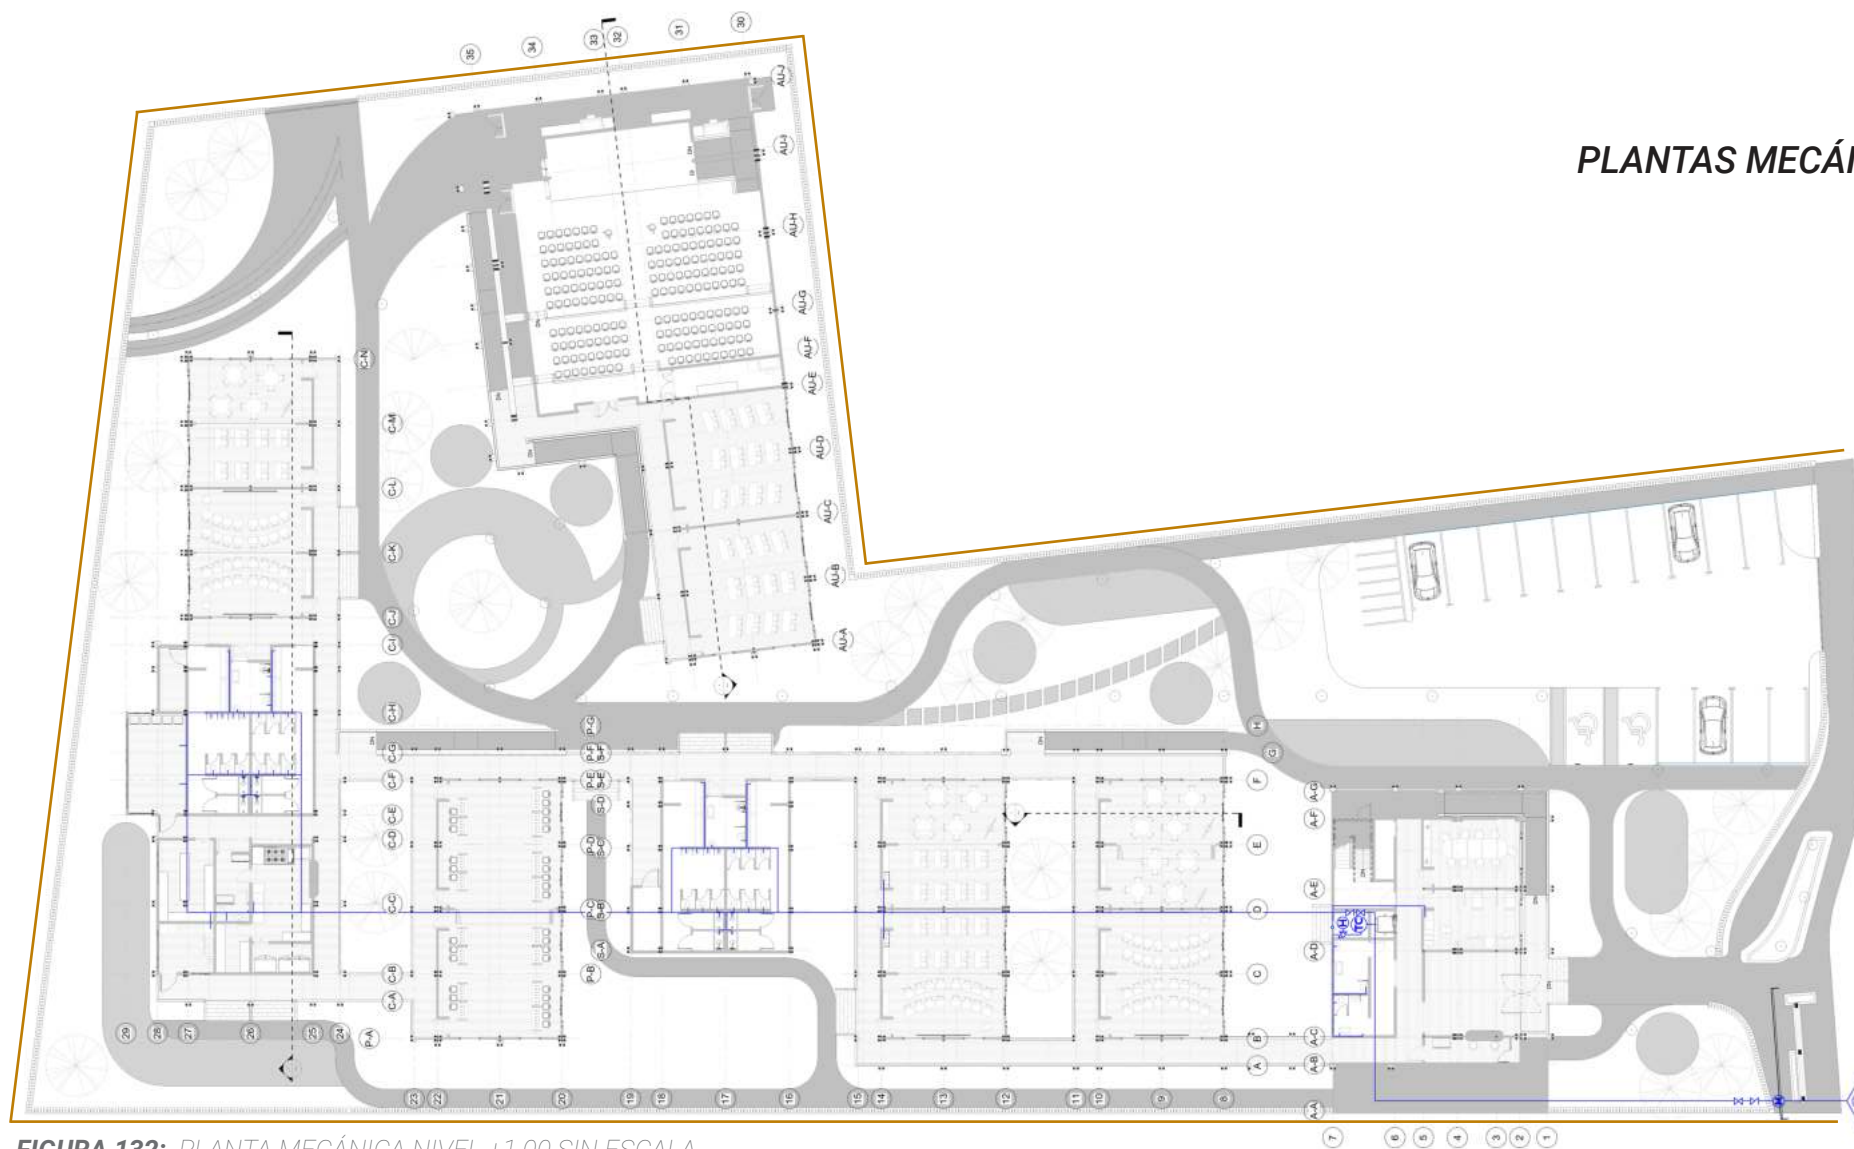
PLANTA MECÁNICA NIVEL +1.00 SIN ESCALA
